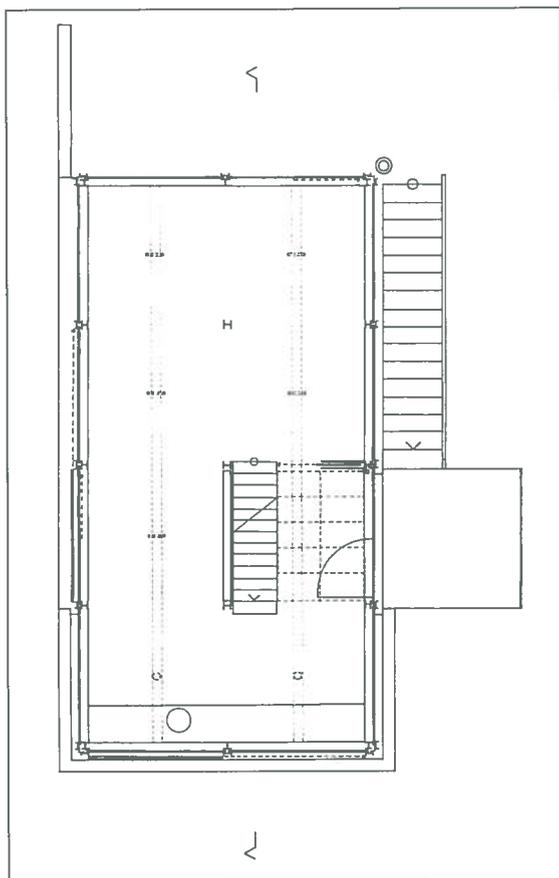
Pianta del primo piano: su questo piano si trovano gli ambienti di soggiorno e la cucina, collocati in continuità all'interno di un unico spazio.
